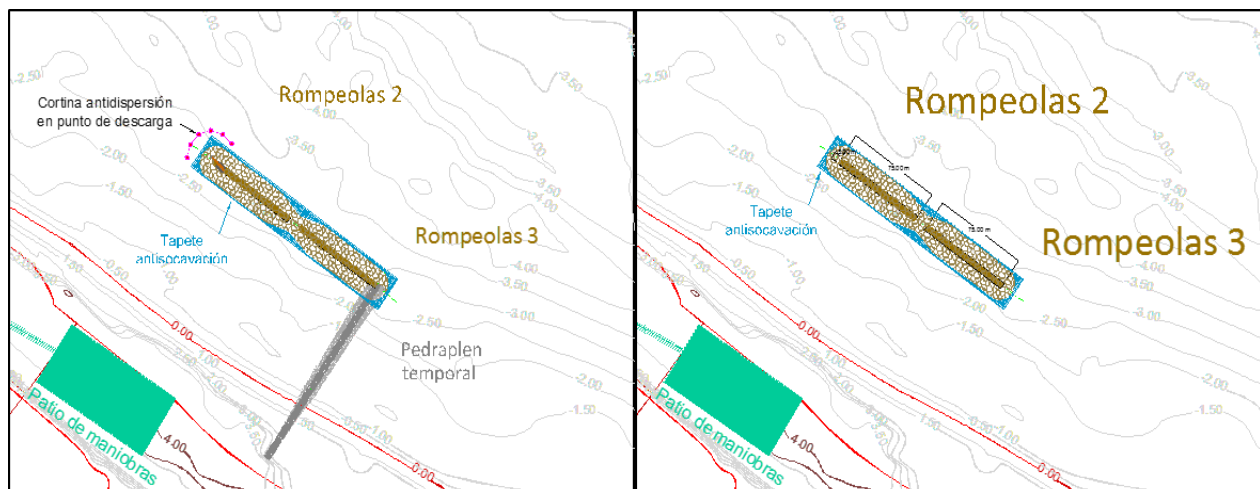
Construcción de rompeolas. A la izquierda, el pedraplén construido hasta alcanzar los Rompeolas 2 y 3; a la derecha, las estructuras terminadas.
